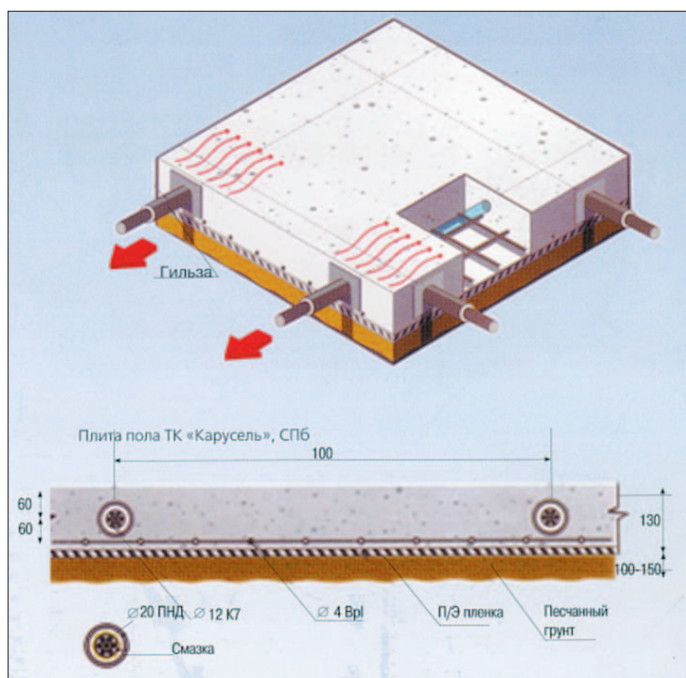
Конструктивные решения промышленных полов (предварительно напряженная железобетонная плита, армированная канатной арматурой, без сцепления арматуры с бетоном)
